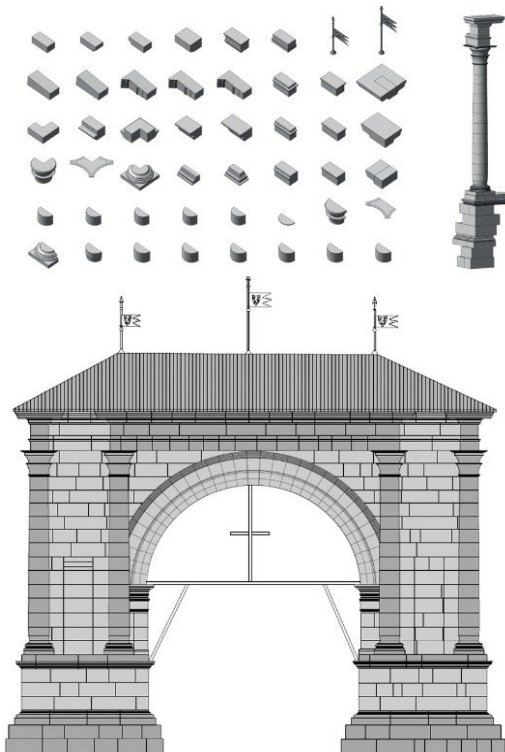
in alto gli elementi delle famiglie di conci, in basso il prospetto ovest
